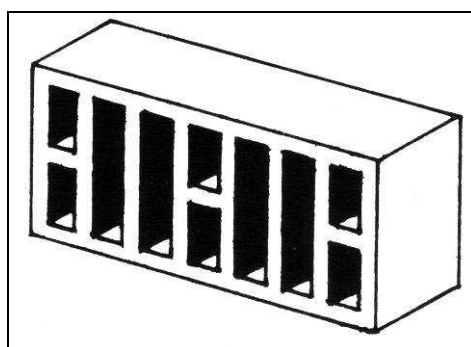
Tijolo de face à vista (40% de vazios), FACINCANI, 1992
